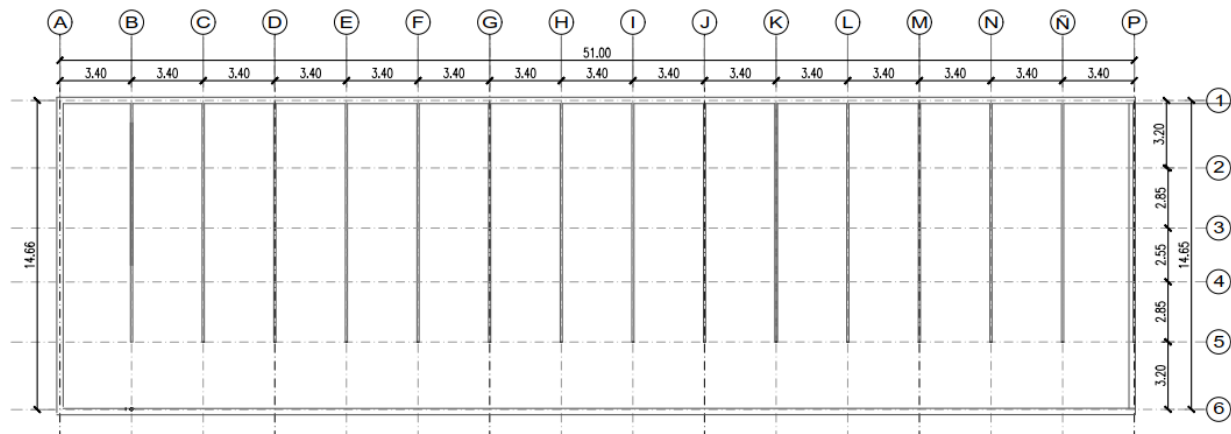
Planta general, Fuente: Elaboración propia de autor
